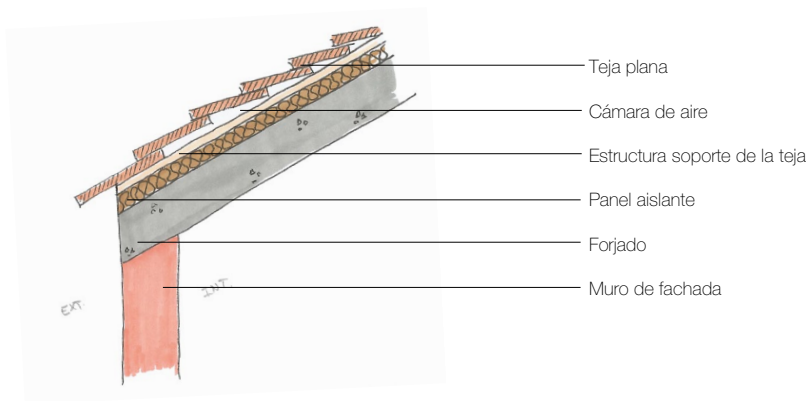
Detalle genérico en sección de cubierta con aislamiento bajo revestimiento exterior (autoría propia).
